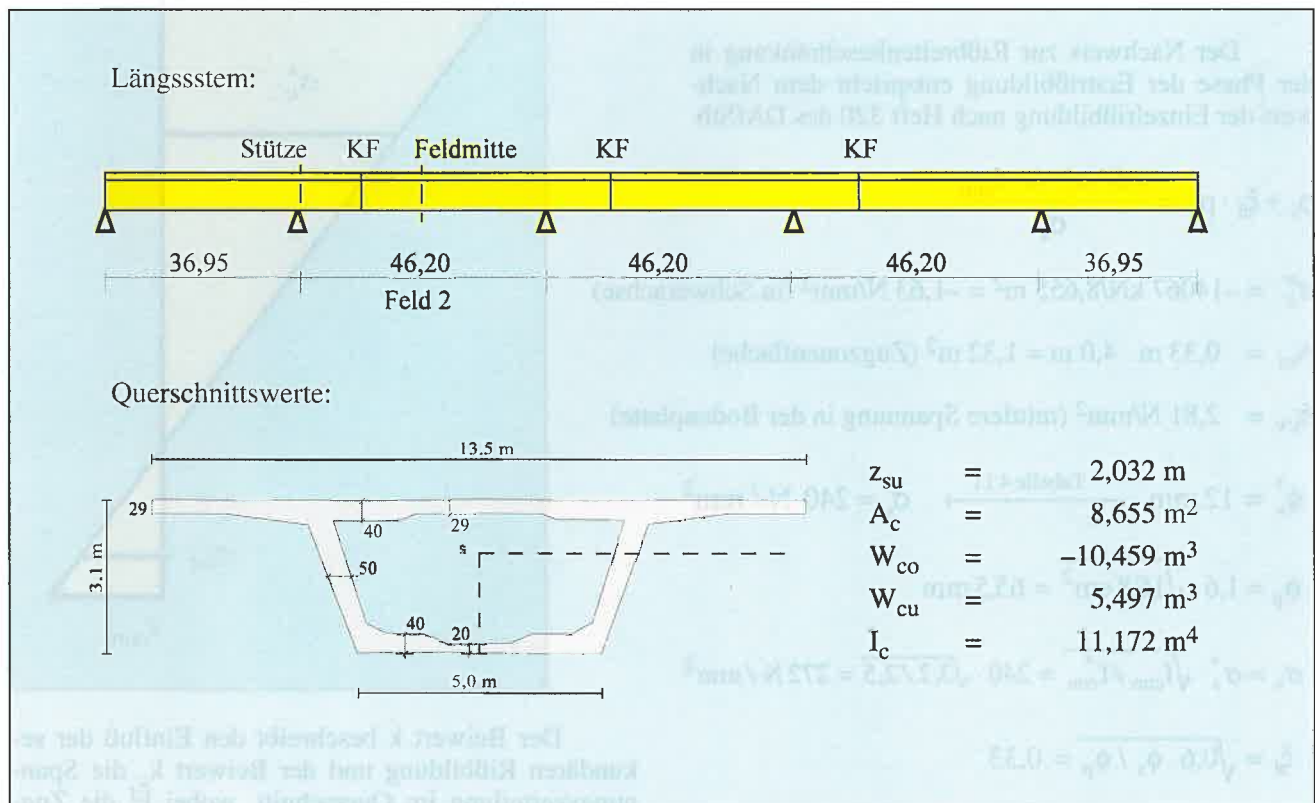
Anwendung der EC2 bei einer teilweise vorgespannten Brücke mit Hohlkastenquerschnitt
